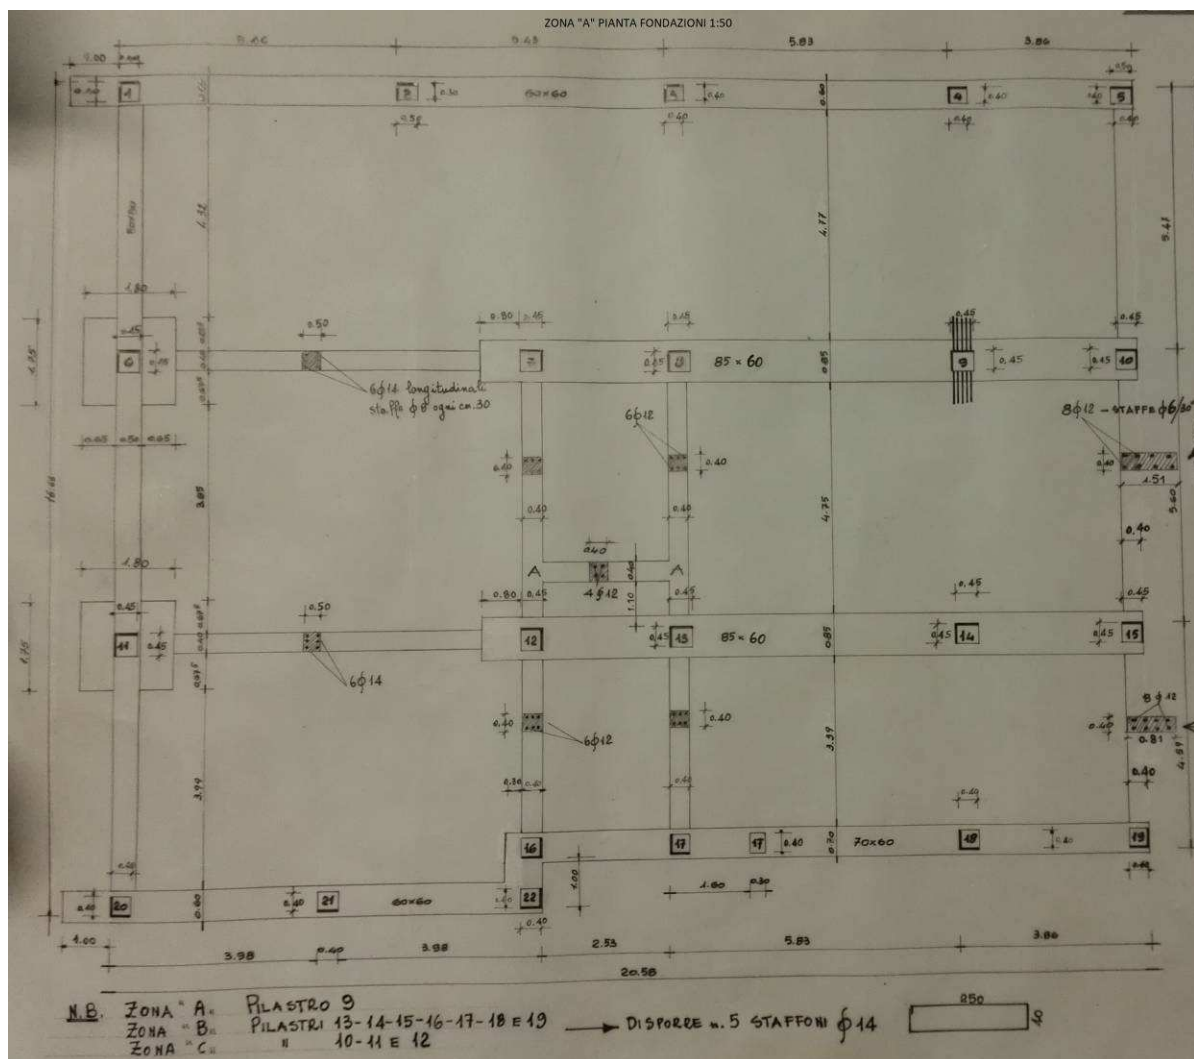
Stralcio del progetto esecutivo reperito Padiglione n.16. – Pianta fondazioni Zona A
